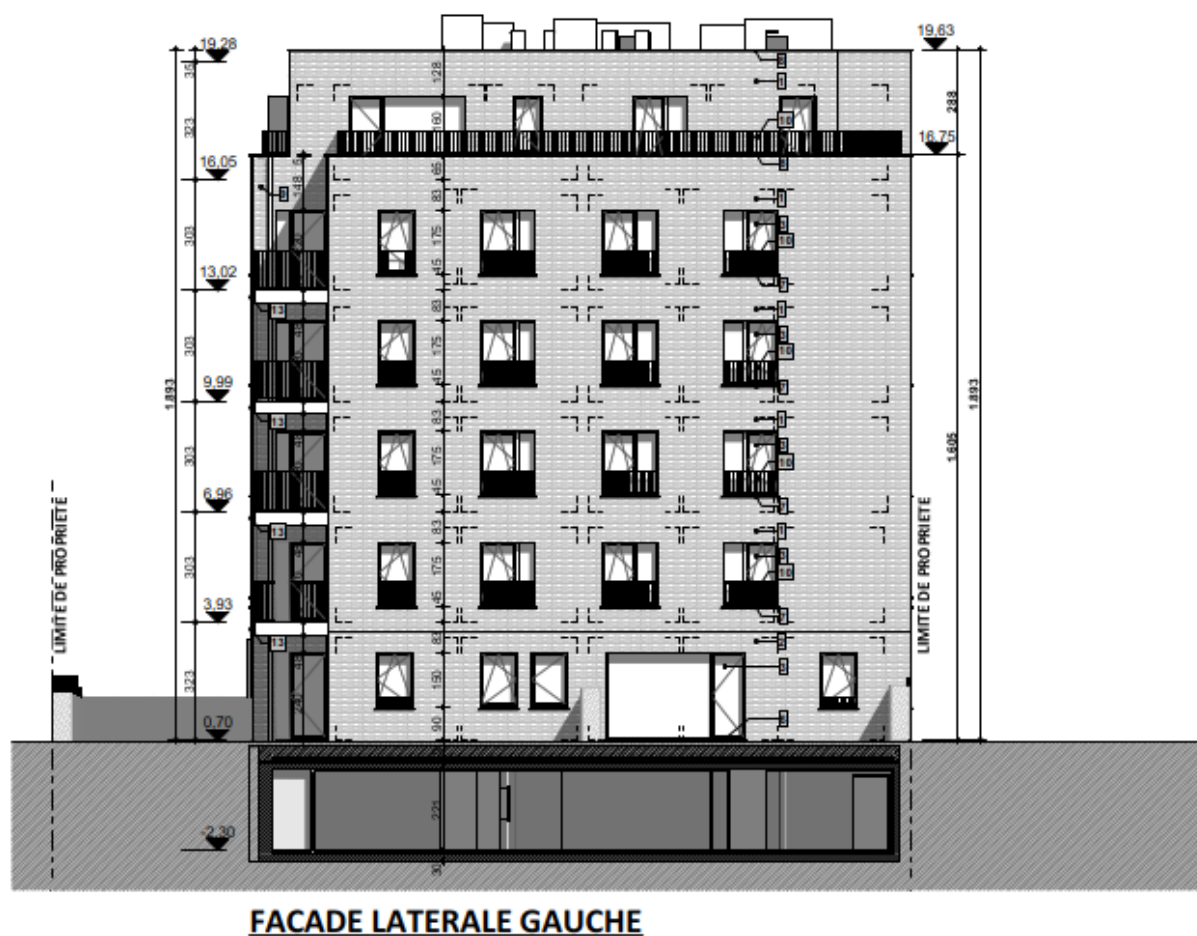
Façade latérale gauche du bâtiment 2 (source : Plans PU)
